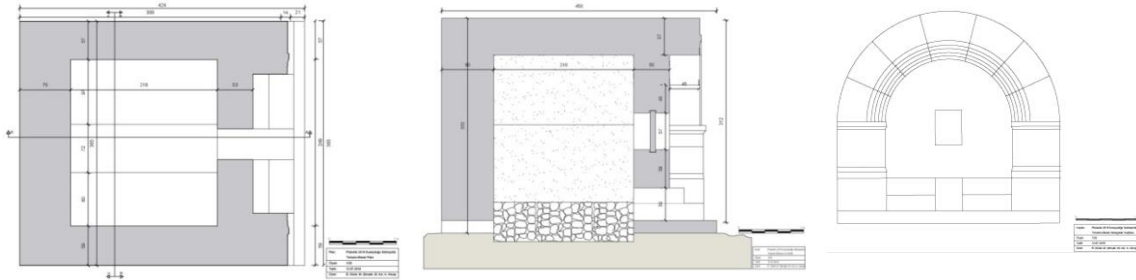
Tonoğlu Mezar Yapısı Plan Kesit ve Cephe Görünümü
